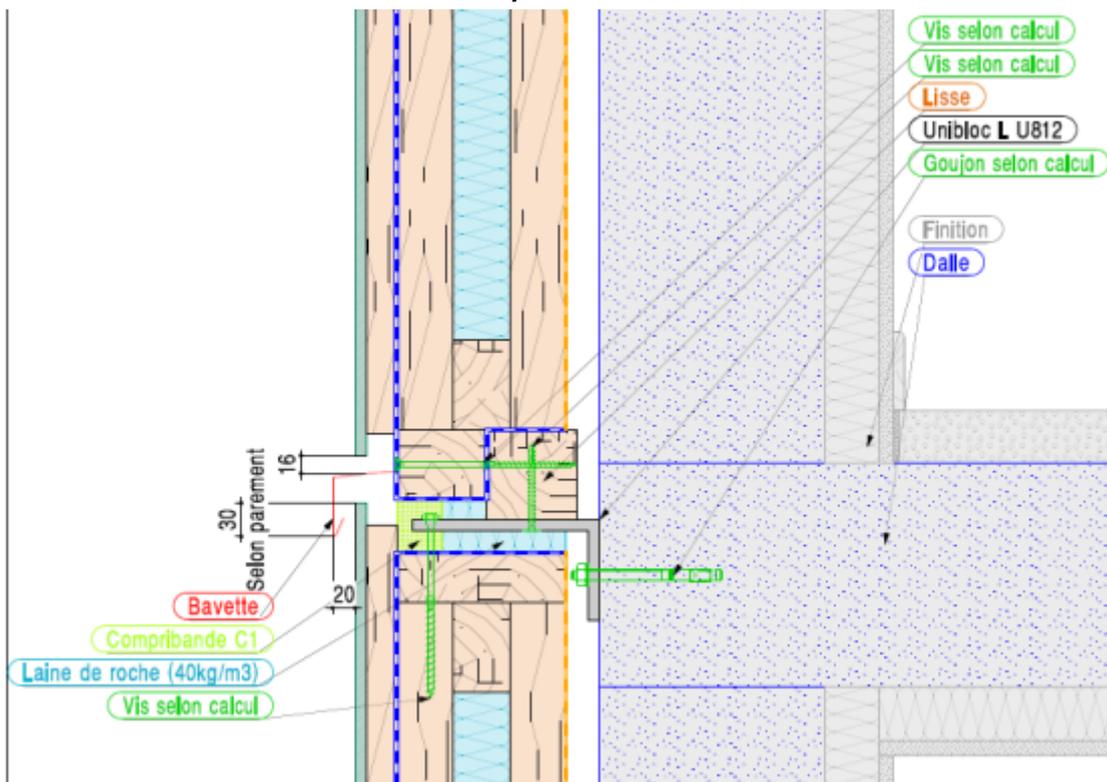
Exemple de raccord de panneaux sur dalle béton, fixation par ancrage standard en nez de dalle, avec parement extérieur ventilé / coupe verticale
